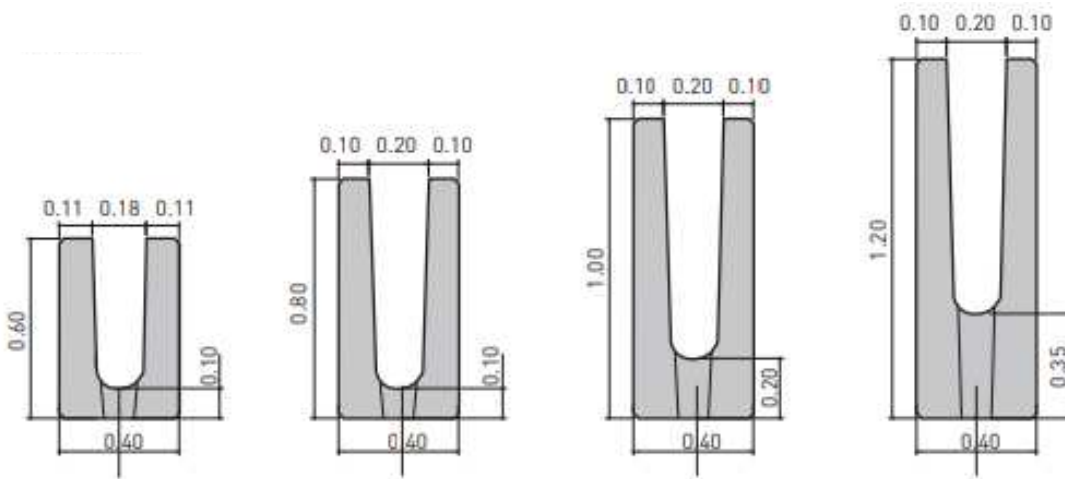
Dimensiones comerciales de vigas “U”. Fuente: Astori Estructuras.
